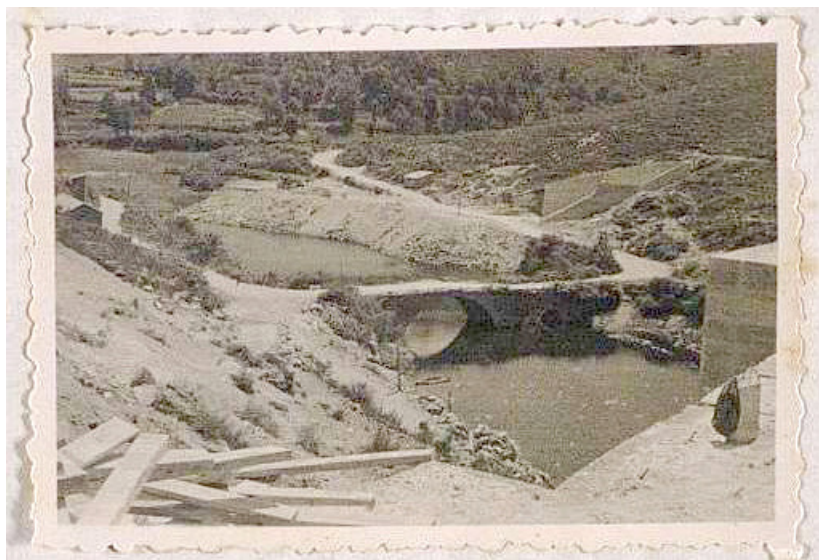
Vista general de Ponte Pedriña desde la presa de As Conchas. Fuente. Informe, 1944.
